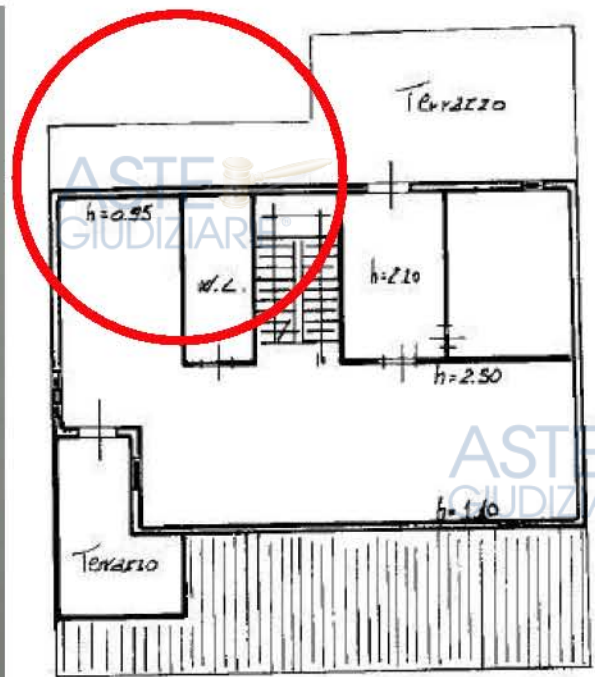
Rappresentazione del prospetto del tetto lato Ovest come da planimetria catastale
